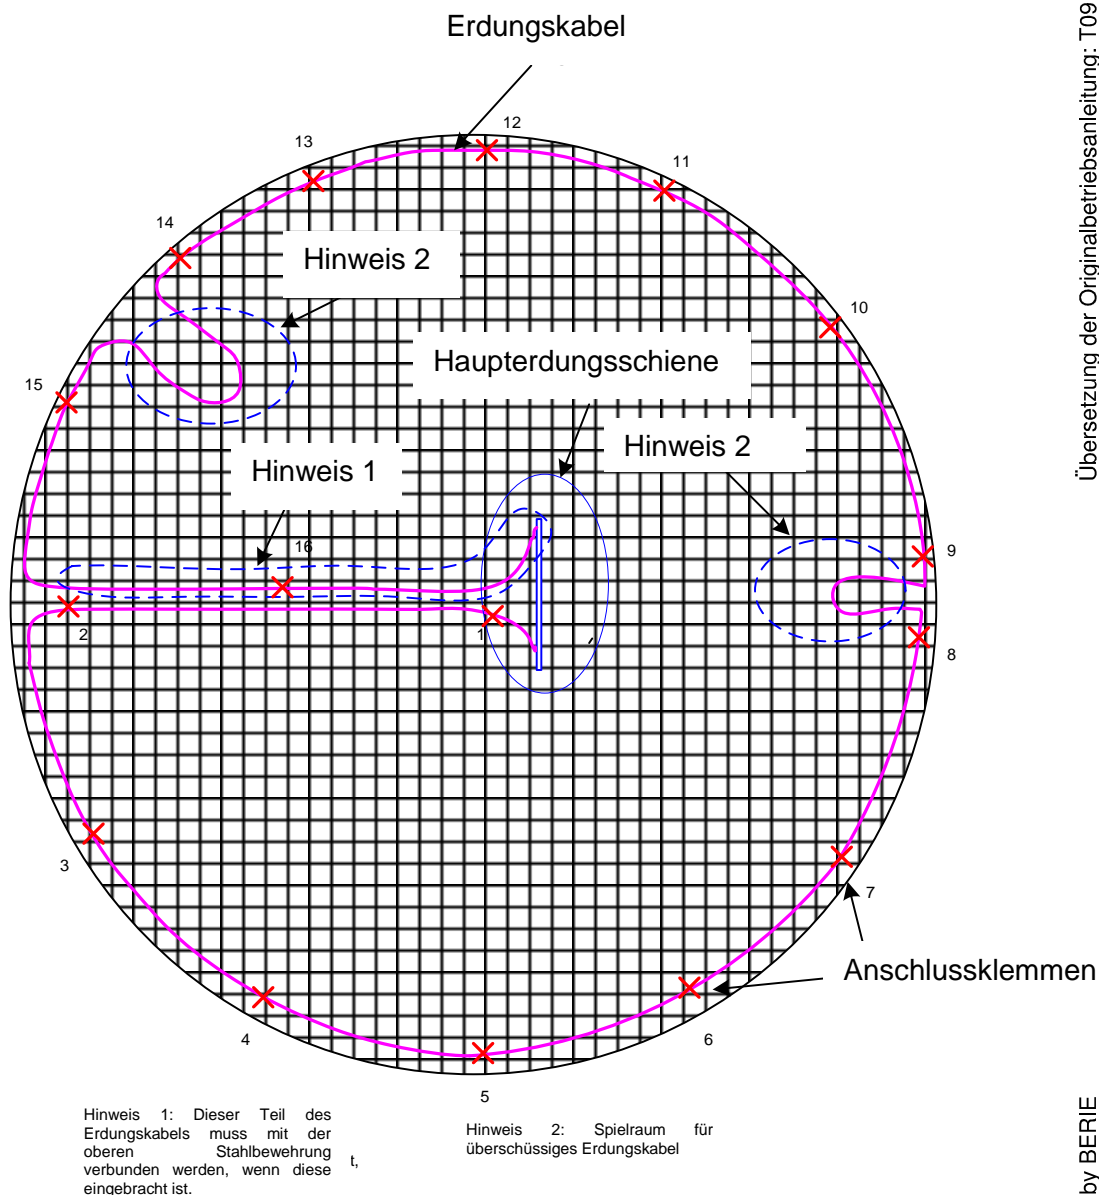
Draufsicht des Fundamentes mit montiertem Erdungsseil
